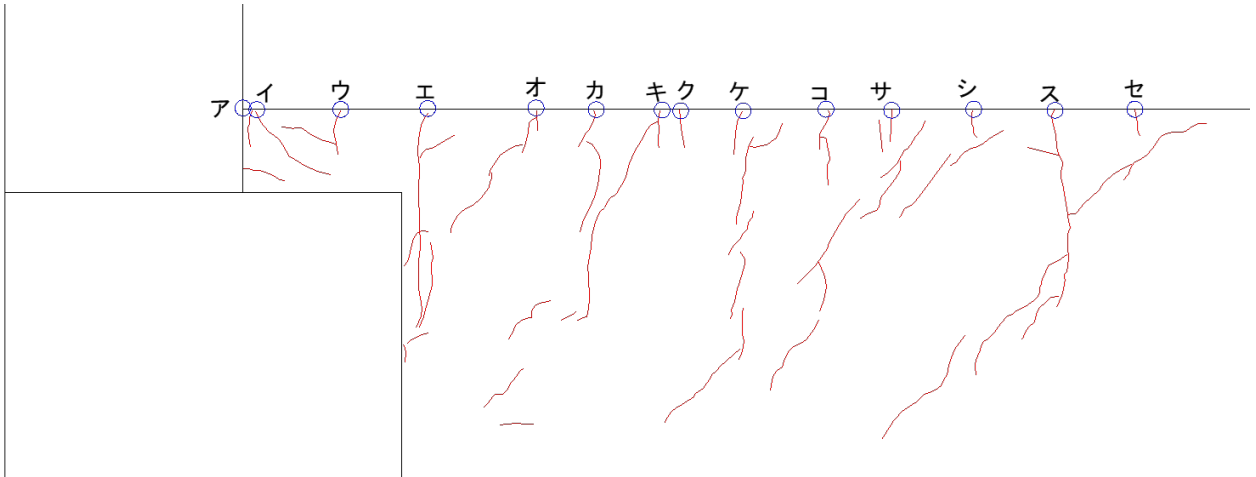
3. 232 基礎梁ひび割れ幅測定位置(試験体 C-1 負載荷)
